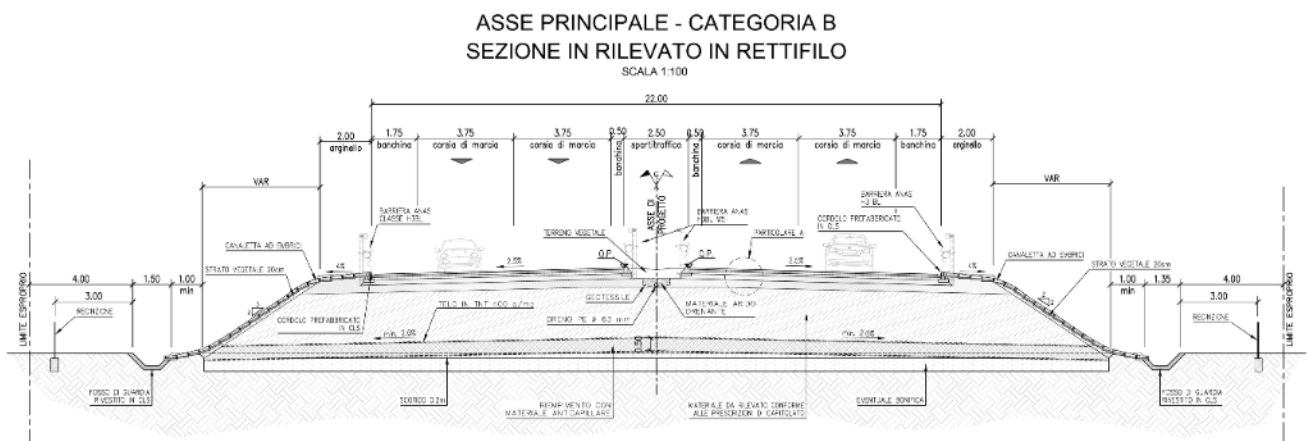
Sezione tipo in rilevato dell'asse principale
